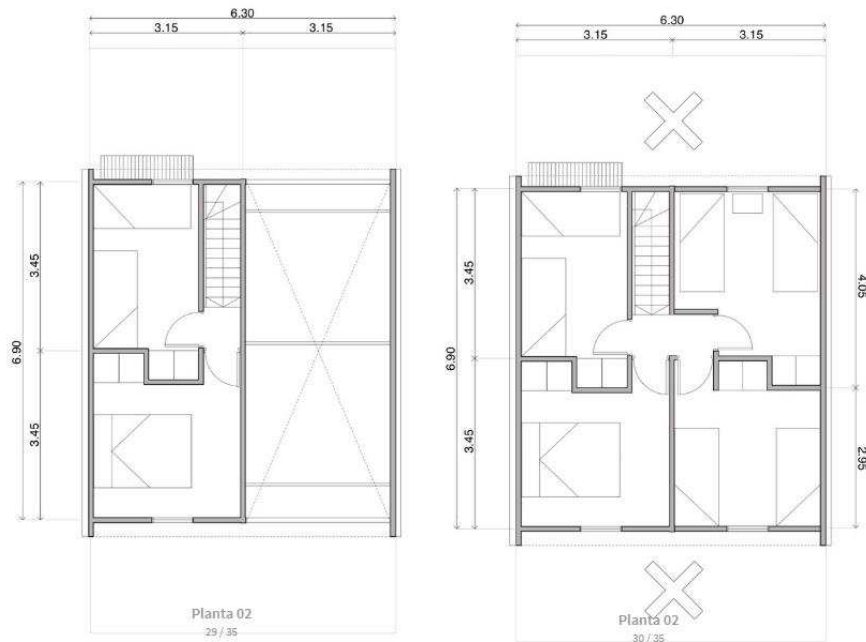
Proyecto de vivienda de interés social progresiva “Villa Verde” – Planta arquitectónica Alta
